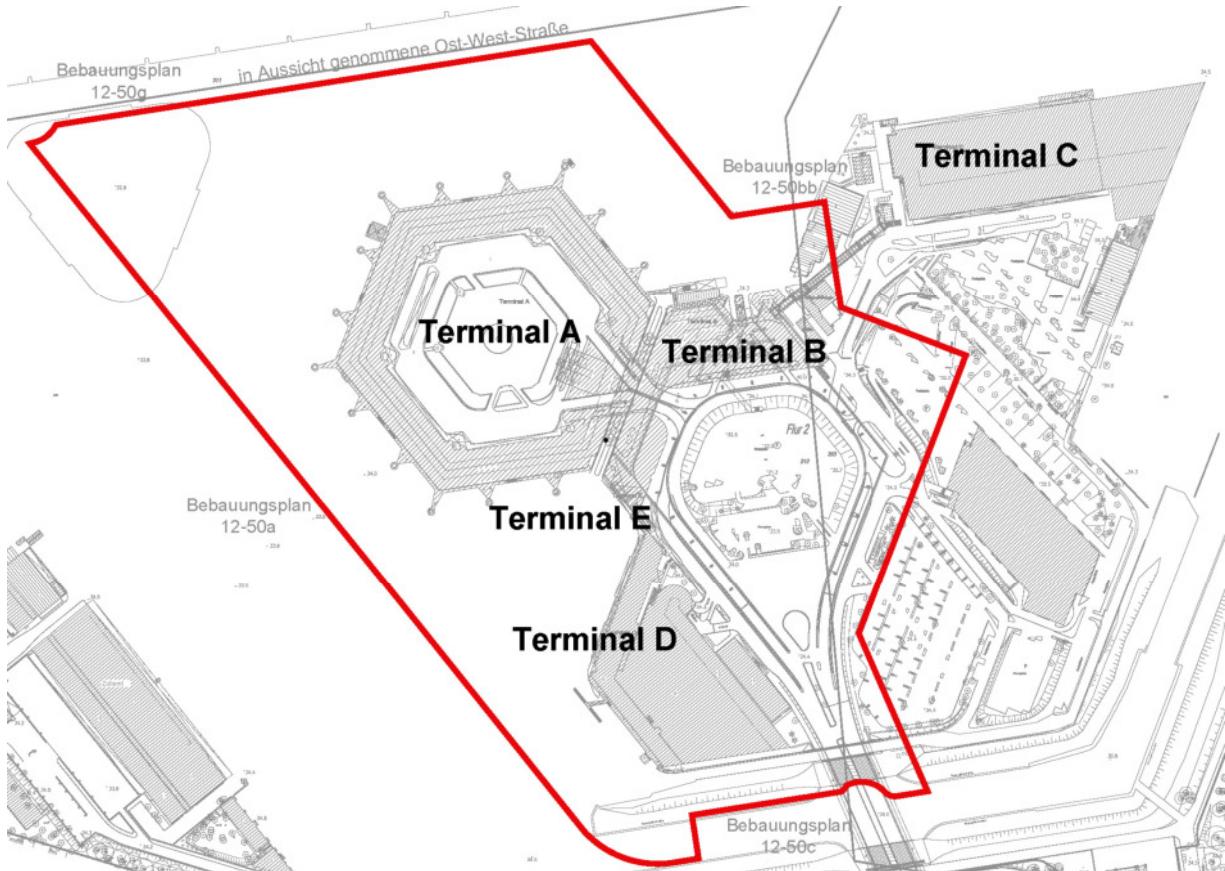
Terminal-Bestand mit Abgrenzung des Bebauungsplans 12-50ba
